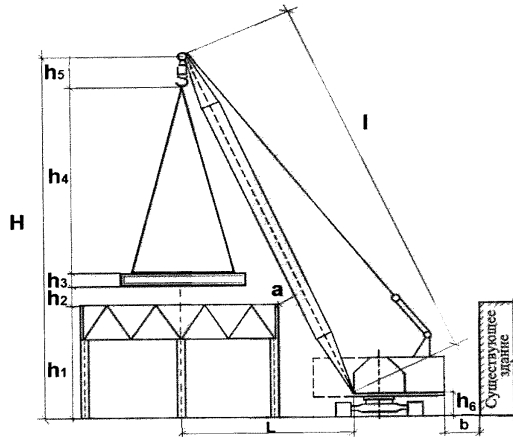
Монтаж конструкций, выполняемый через верх здания
